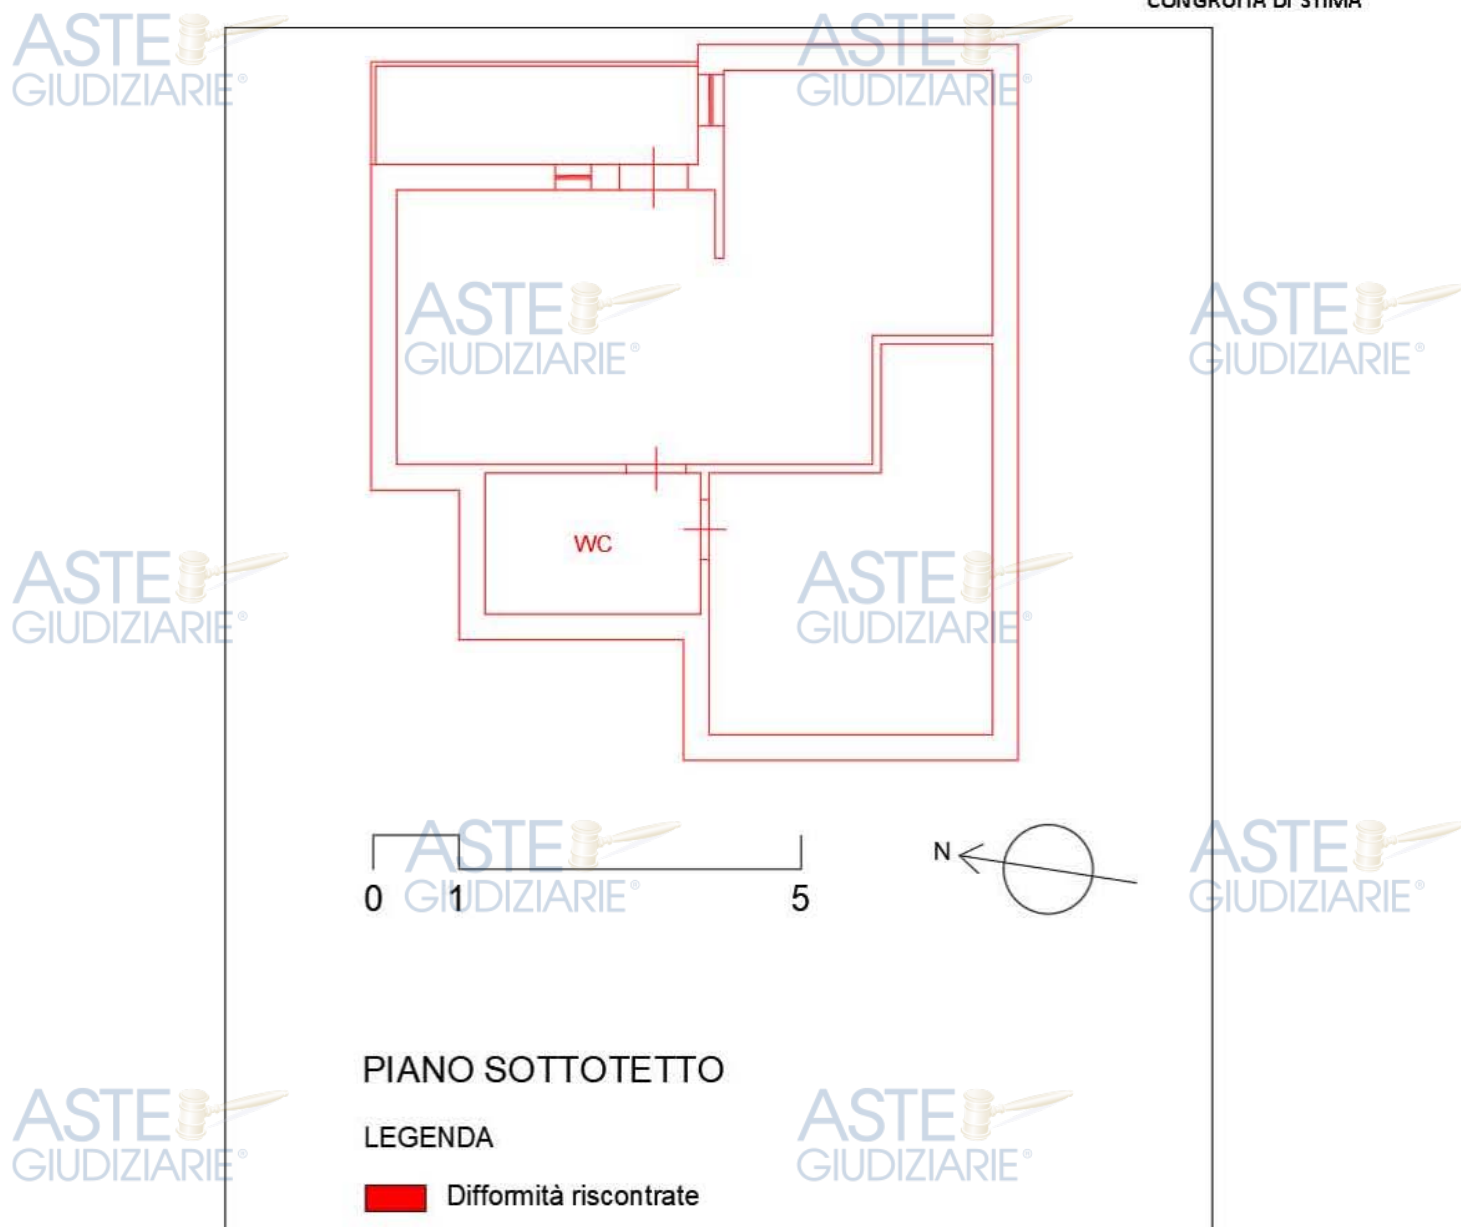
Difformità riscontrate rispetto la planimetria catastale: piano sottotetto
